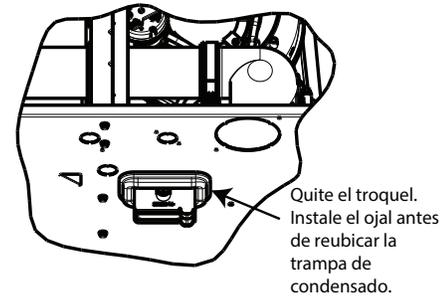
Arandela para la trampa de drenaje horizontal ^{A11582SP}
